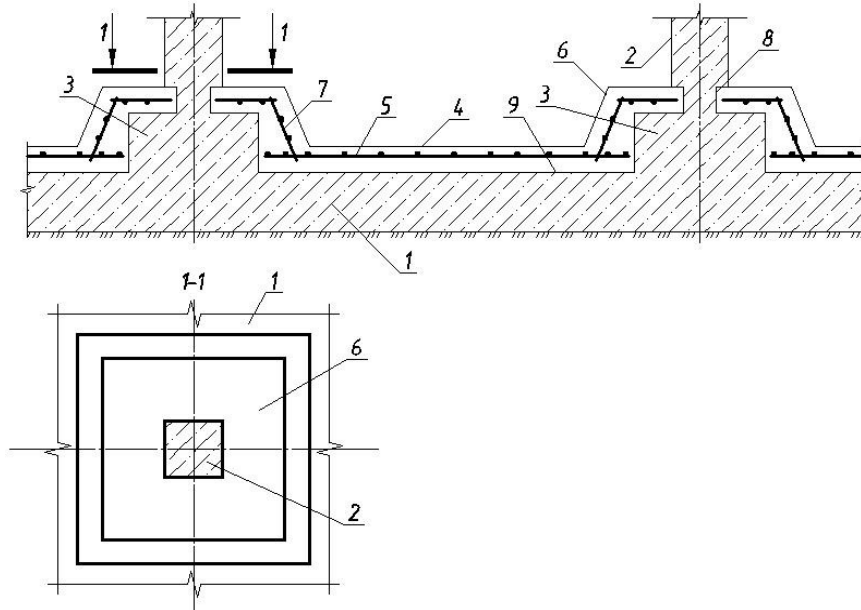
Нарощування плити зверху при забезпеченні зчеплення поверхонь:
